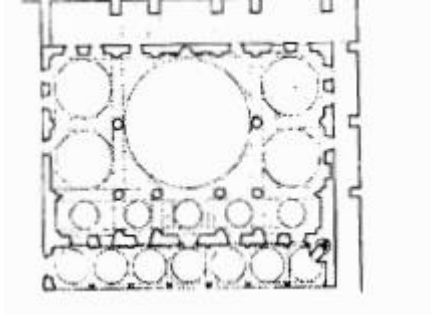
مسقط أفقي للجامع الكبير بتقرت عن:
